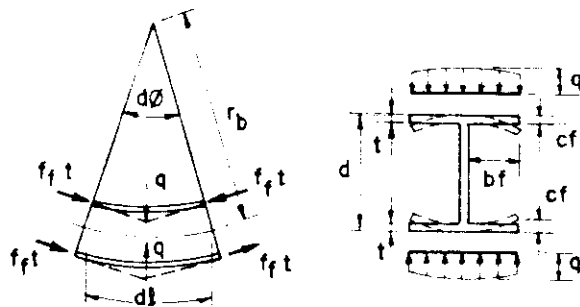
Ondulação da mesa para vigas I. [59]
